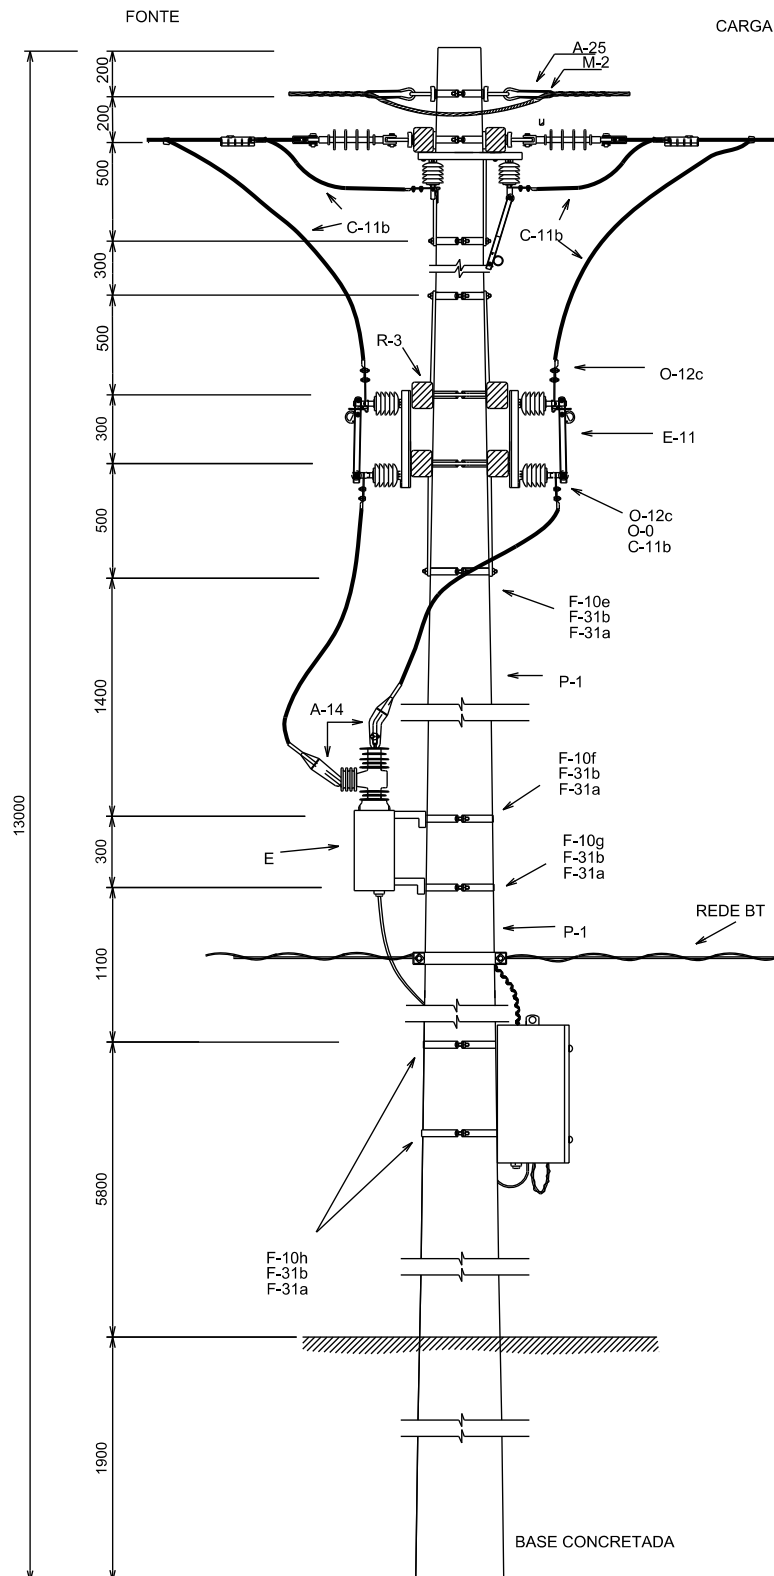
Estrutura CEM4-4M para instalação de religadores em áreas urbanas.
